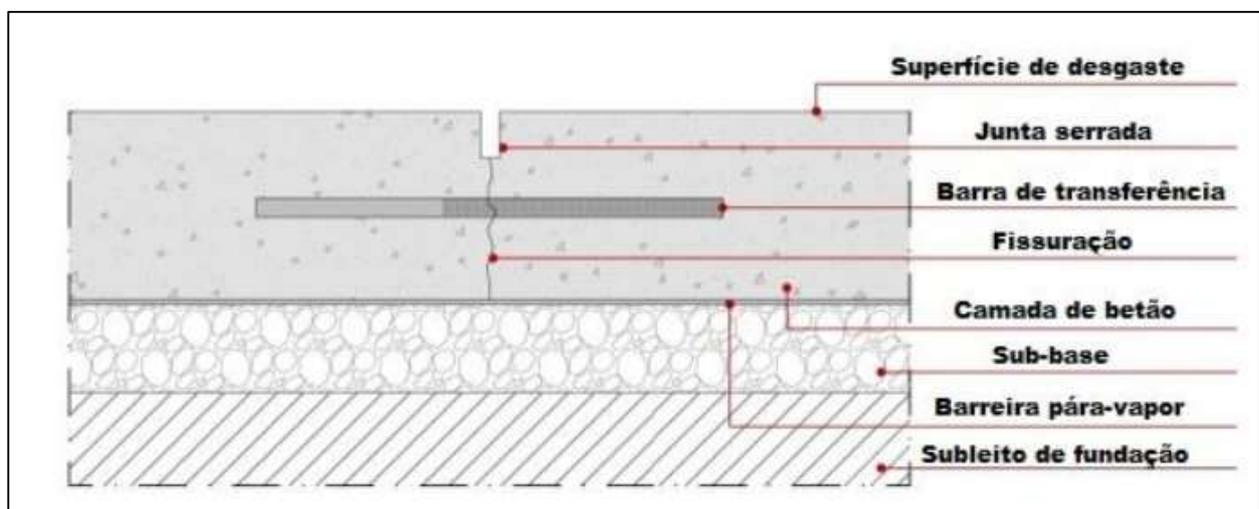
Perfil de pavimentos de betão simples.¹⁶
